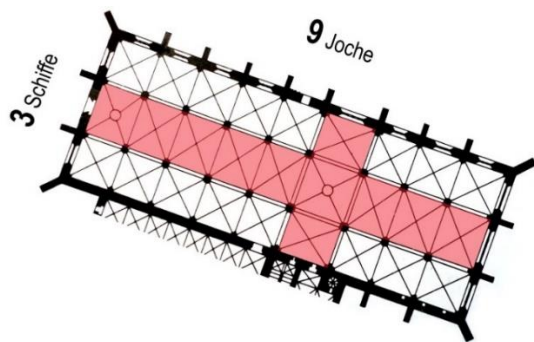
Münster Neuberg, Grundriss der dreischiffigen, neunjochigen Anlage mit integriertem Kreuz mit Zentrum Vierung.
